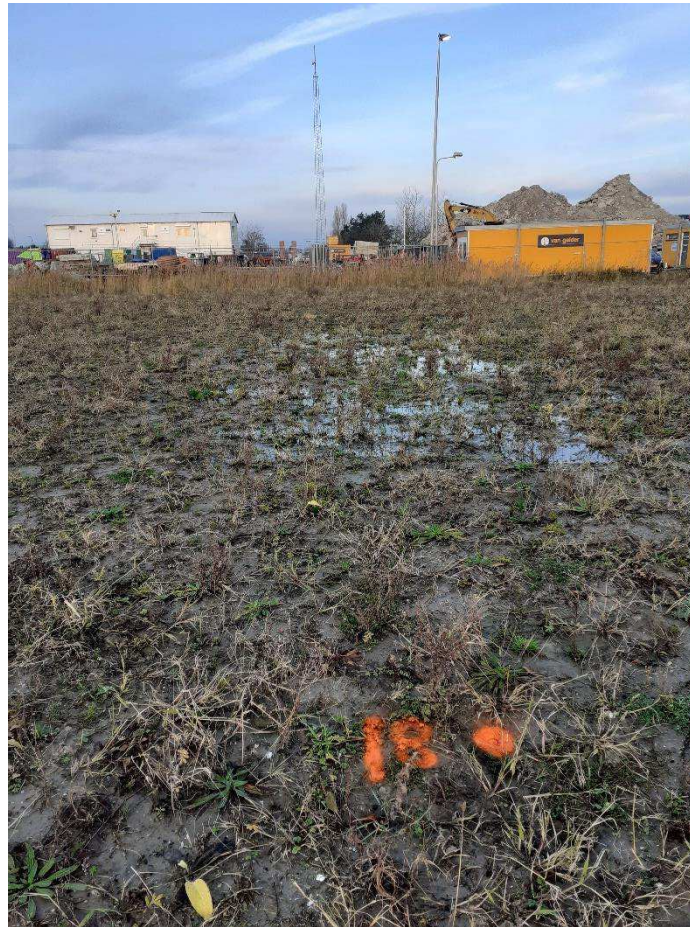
Zuidelijkdeel (kijkrichting ten noorden)
